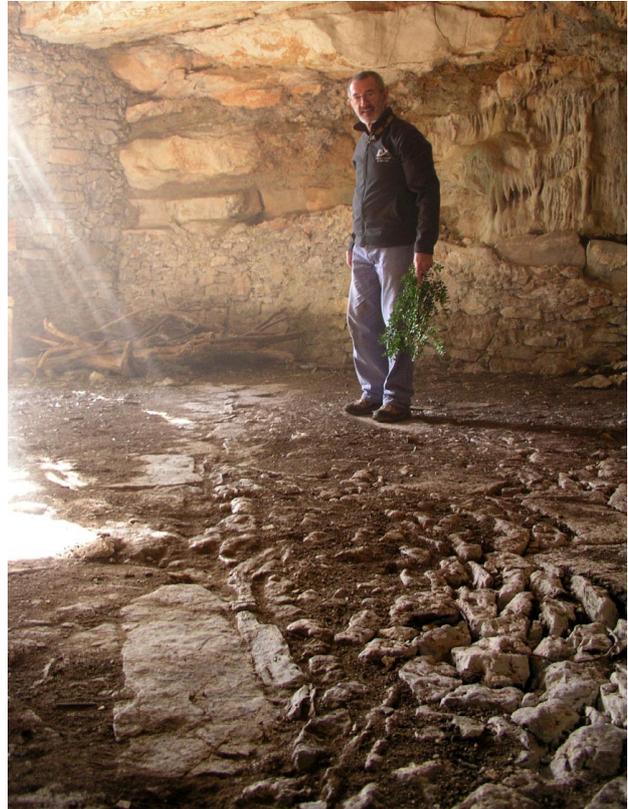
Dallage de la grotte de la Jasse, Gornières, Hérault : pierres sur chant à droite pour l'âne et grandes dalles de pierres à gauche pour l'homme.
